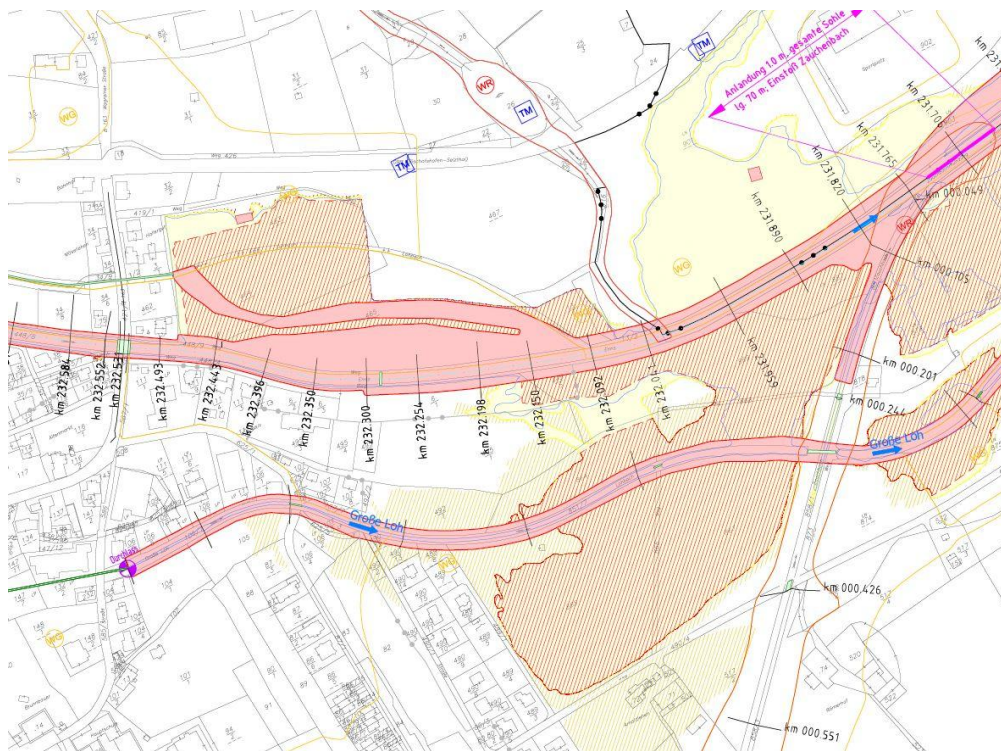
Lageplanausschnitt Enns mit Darstellung der Gefahrenzonen
